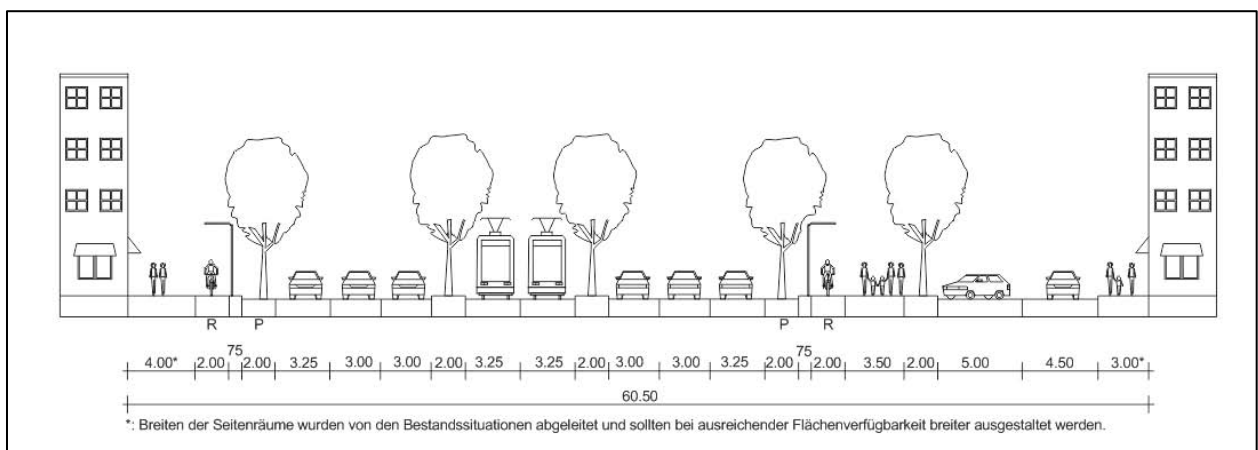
Vorschlag eines empfohlenen Straßenquerschnitts einer urbanen Hochleistungsstraße mit einem Querschnitt von 60,5 m und 6 Fahrstreifen mit besonderem Bahnkörper in Mittellage und Parallelerschließung
